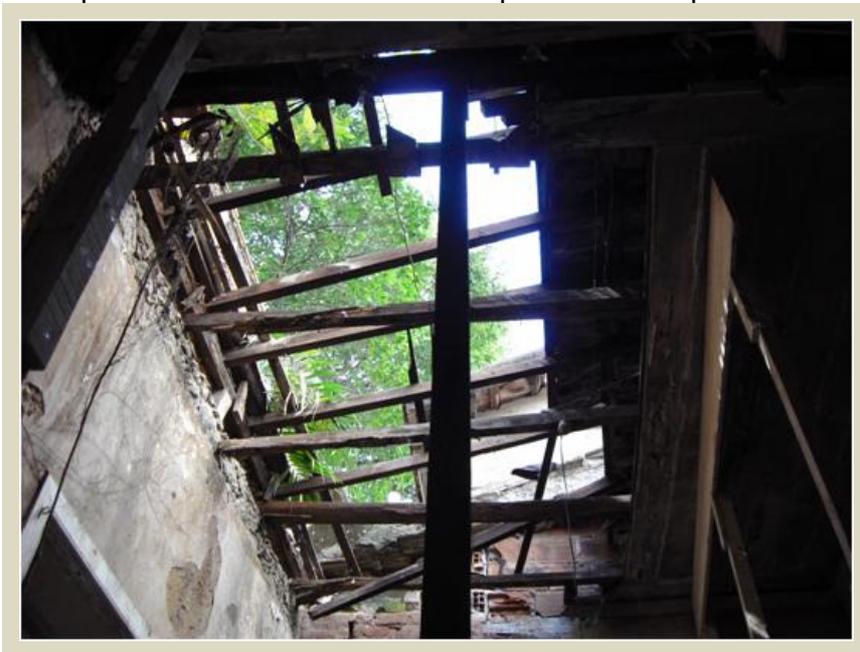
Cobertura com madeiramento podre e falta de telhas.
